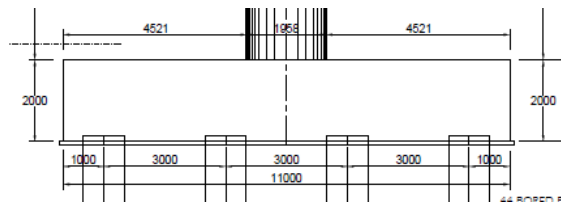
11 Detail *Pile Cap* Abutment A1
